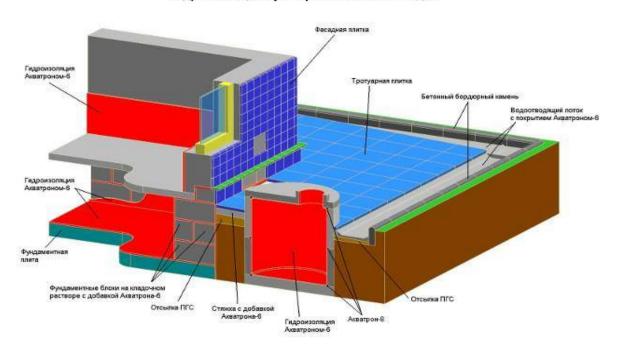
Гидроизоляция при строительстве коттеджа
